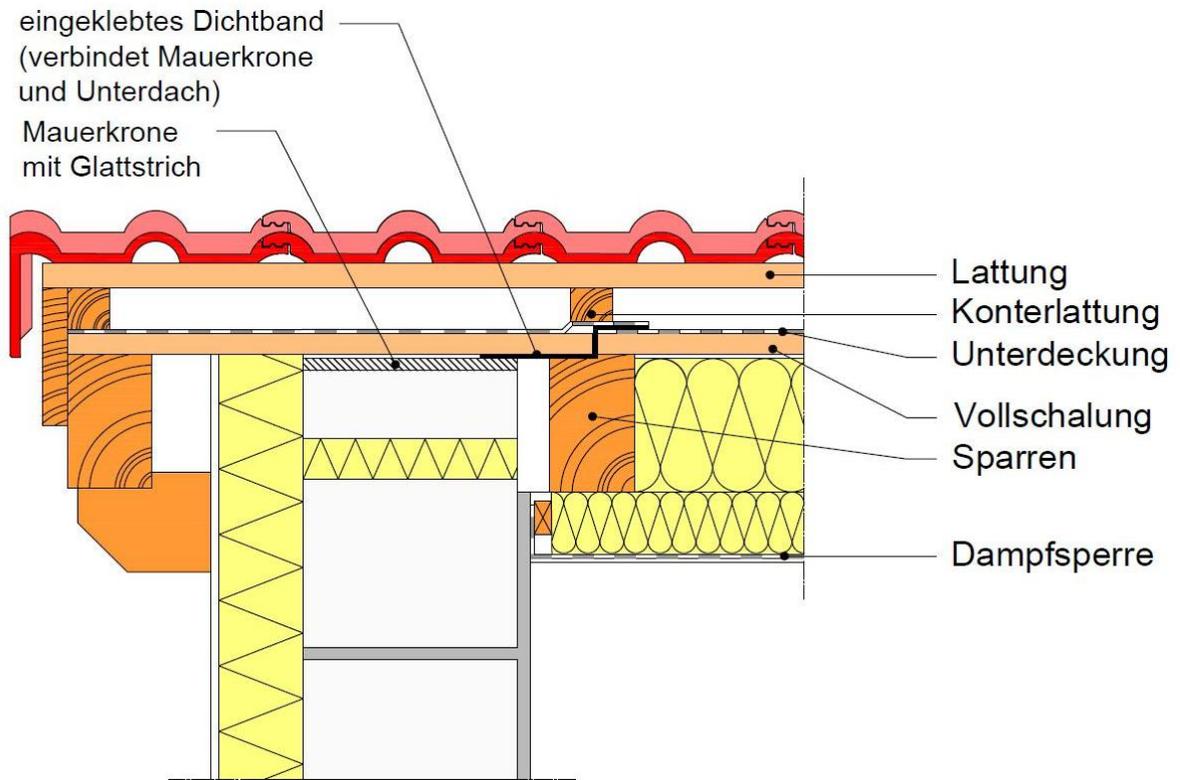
Ortgang mit Ortgangstein und winddichtem Anschluss des Unterdaches
